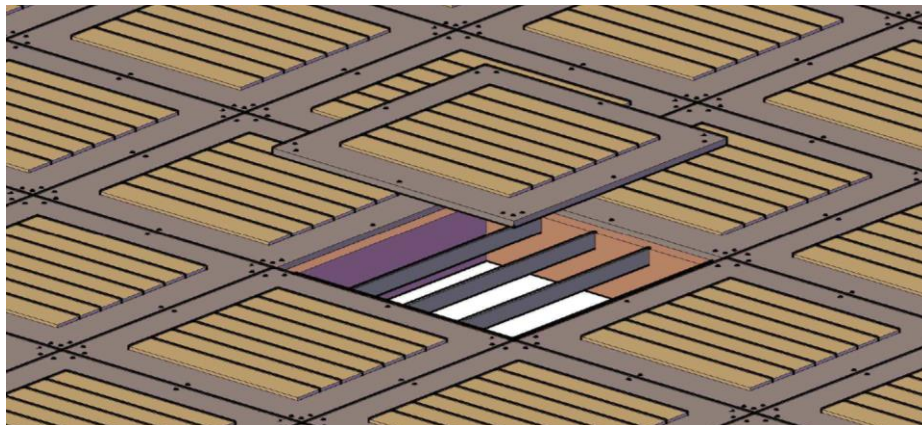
Perfis metálicos entre as vigas e sob o painel de piso, impedindo a flexão deste.
